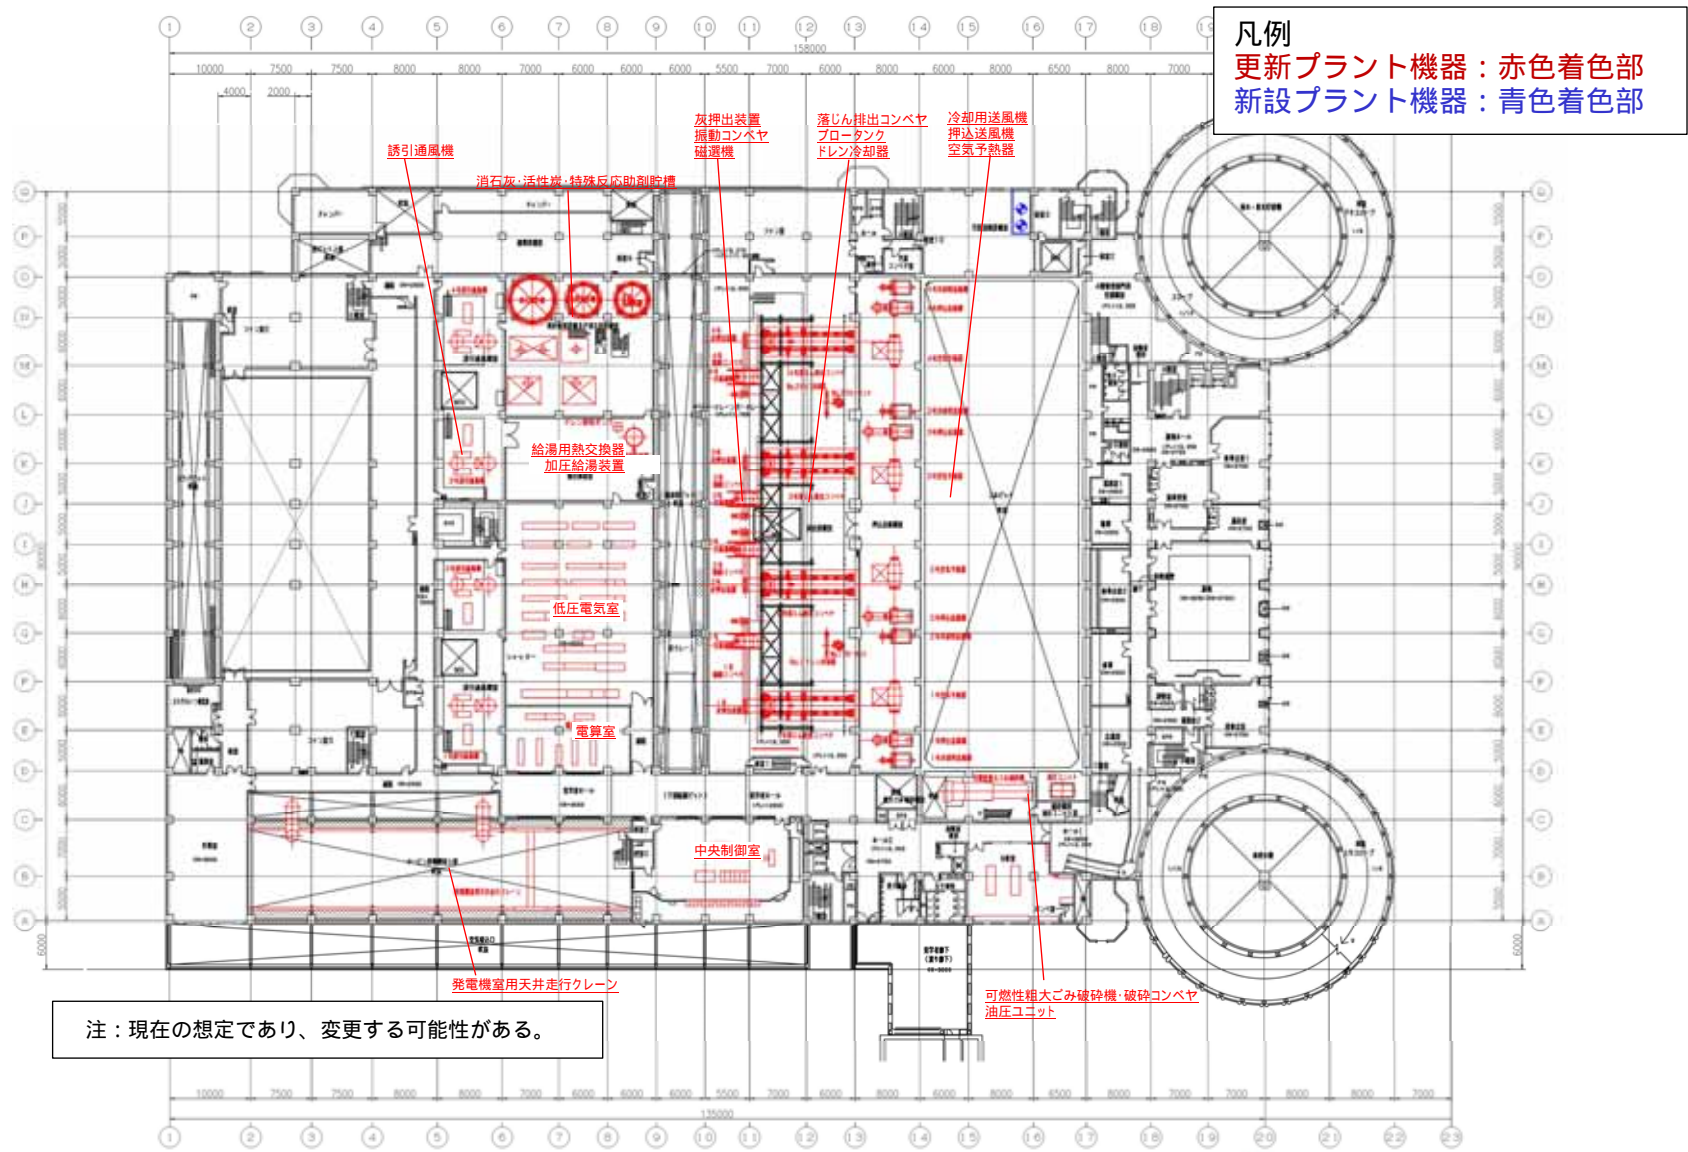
(4) 設備機器の更新箇所（4階平面図）
